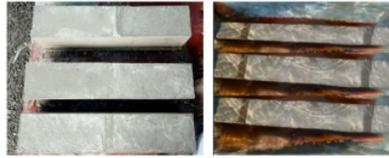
Menuangkan Beton ke Dalam Pan
